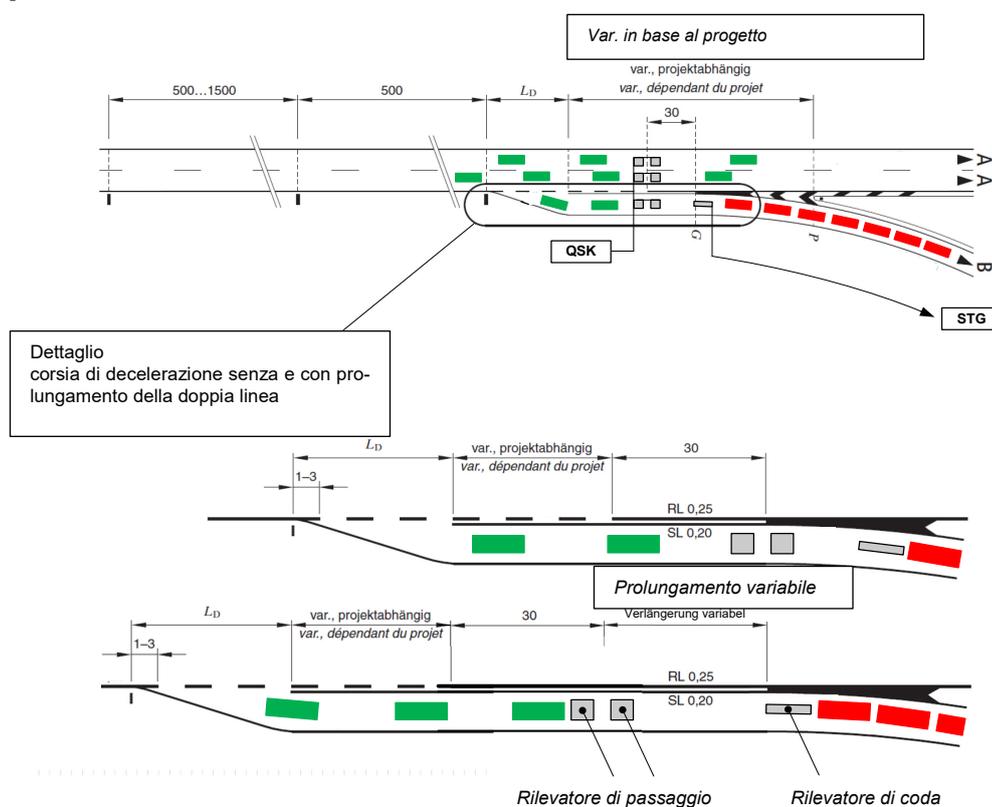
Posizionamento del rilevatore di coda e del rilevatore combinato di coda e di passaggio sulla corsia di decelerazione
